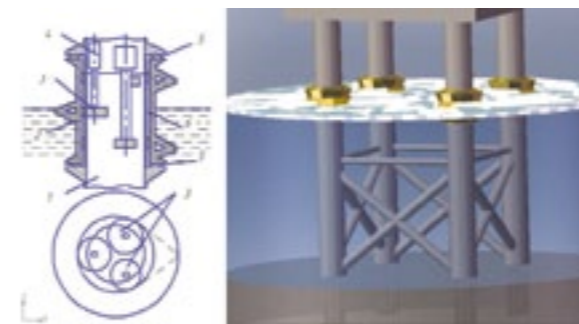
Схема ледорезов винтового типа на колонне многоопорной платформы: 1 — колонна; 2 — винтовой корпус с резьбой; 3 — зубчатое колесо привода; 4 — электродвигатель; 5 — опорные подшипниковые устройства; 6 — зубчатое колесо
